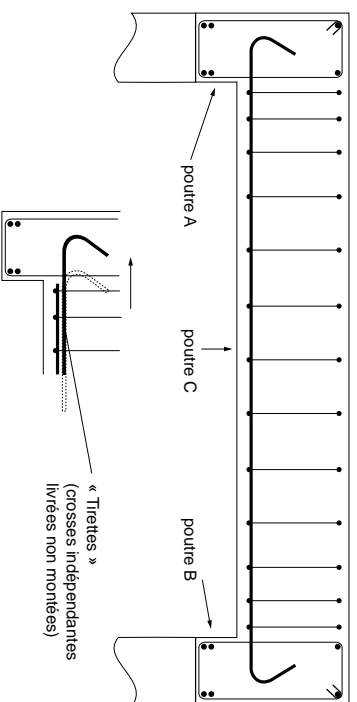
appui d'une poutre sur deux autres poutres - difficultés de mise en œuvre - solution alternative.
